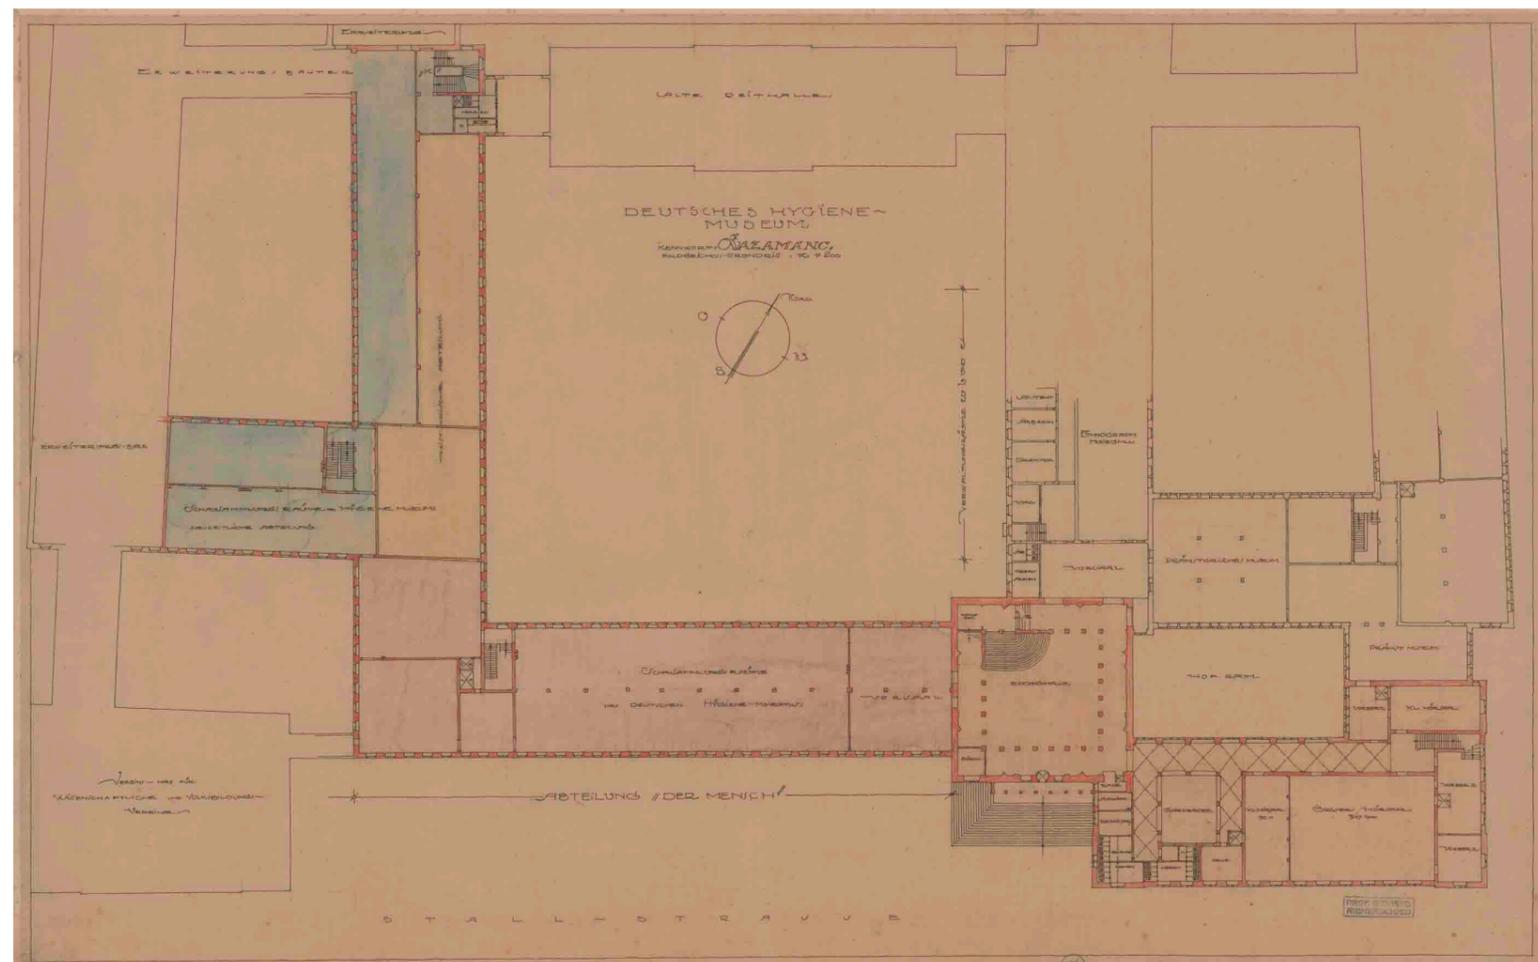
Bauabschnitt Hygiene Museum (Grundriss EG)
